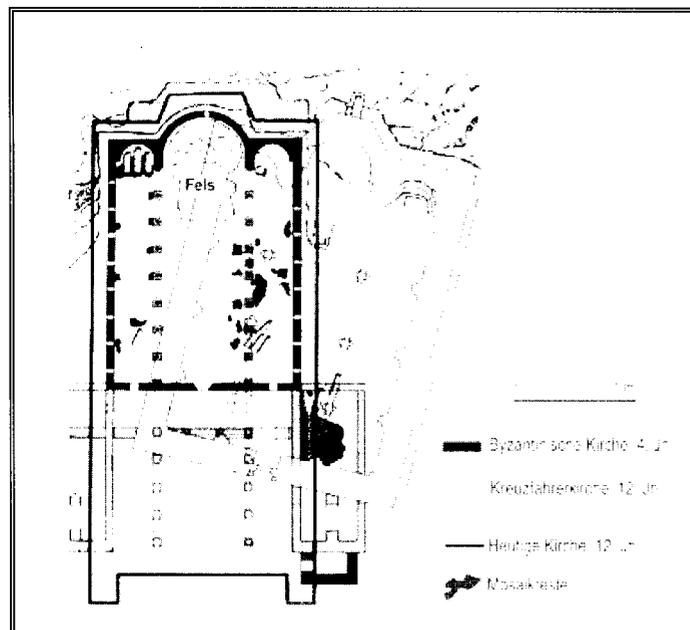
Kirche der Nationen: Grundriss der Kirche, mit Hervorhebung der Grundrisse verschiedener Vorgängerkirchen
